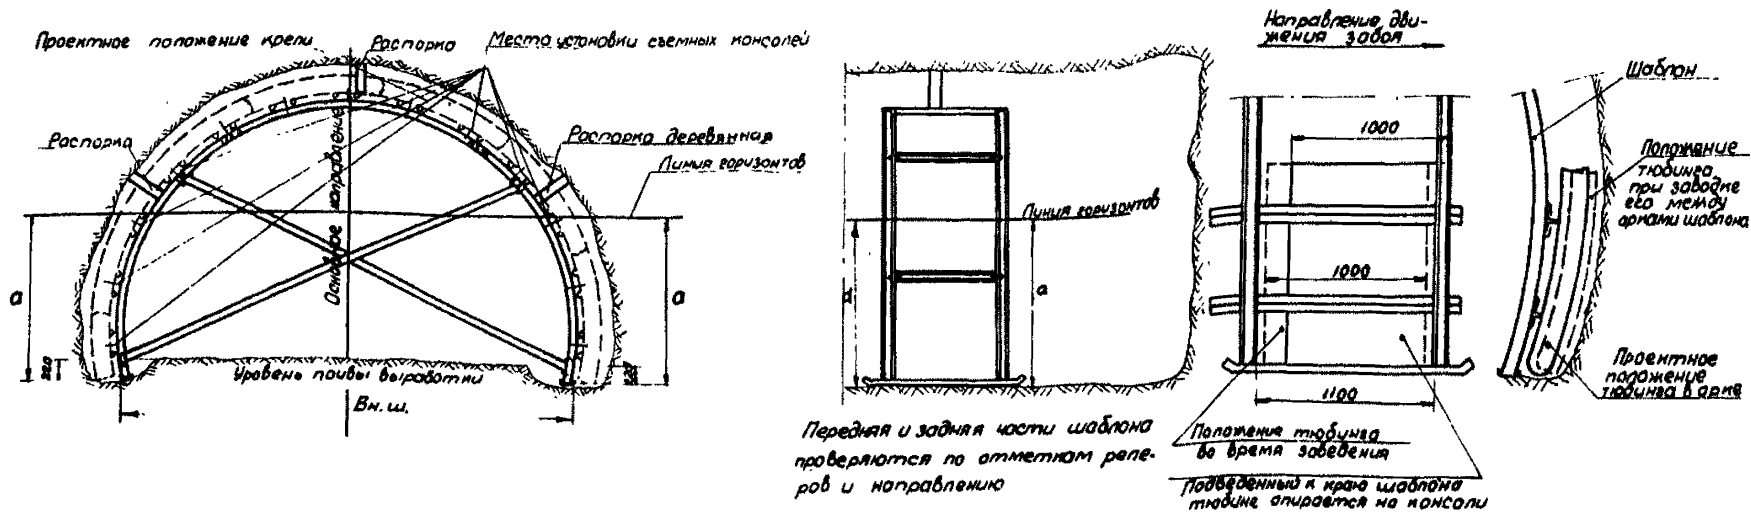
Рис. I. Металлический шаблон для установки парных арок тубинговой крепи
